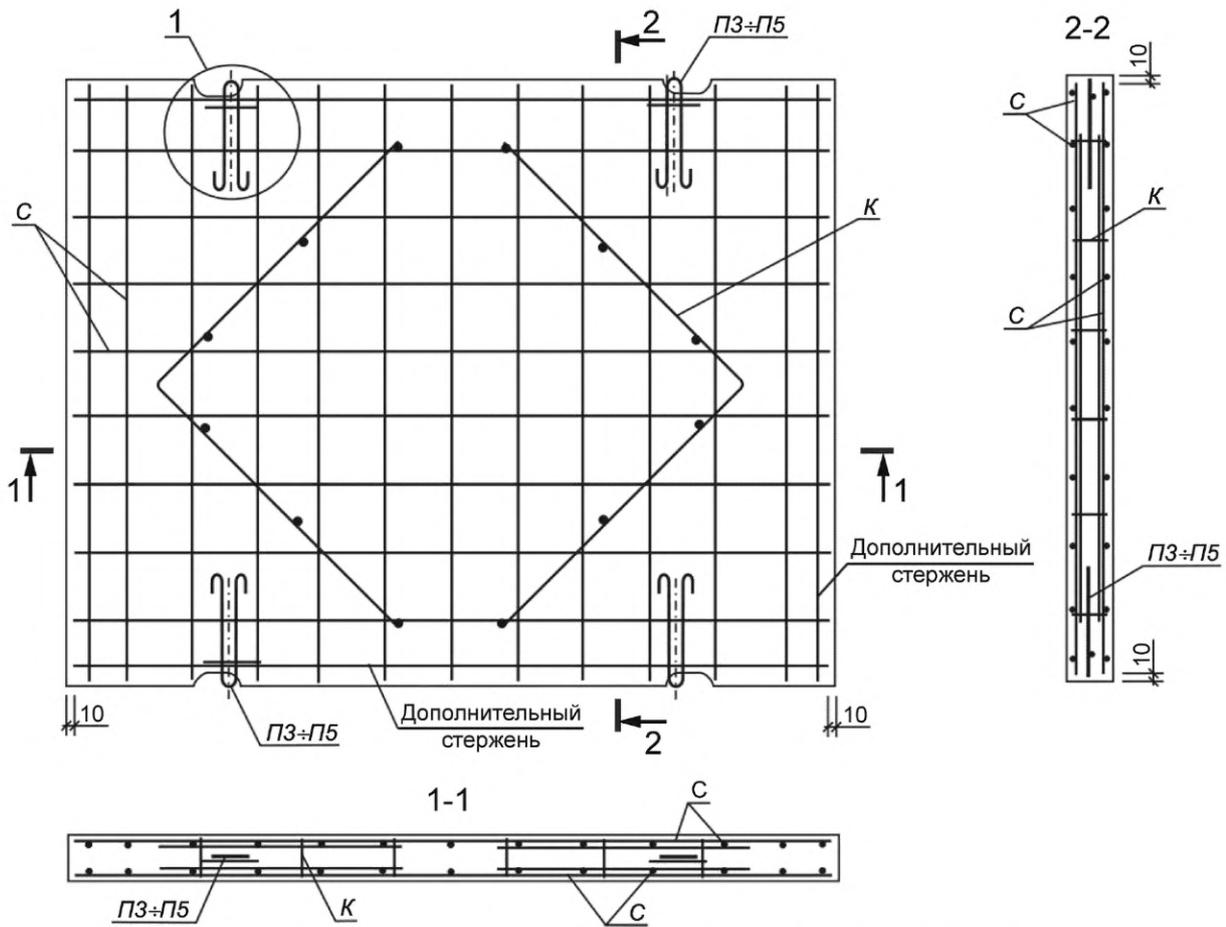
Схема армирования плит: ПЗ5.28, ПЗ0.18, П18.18, П18.15
